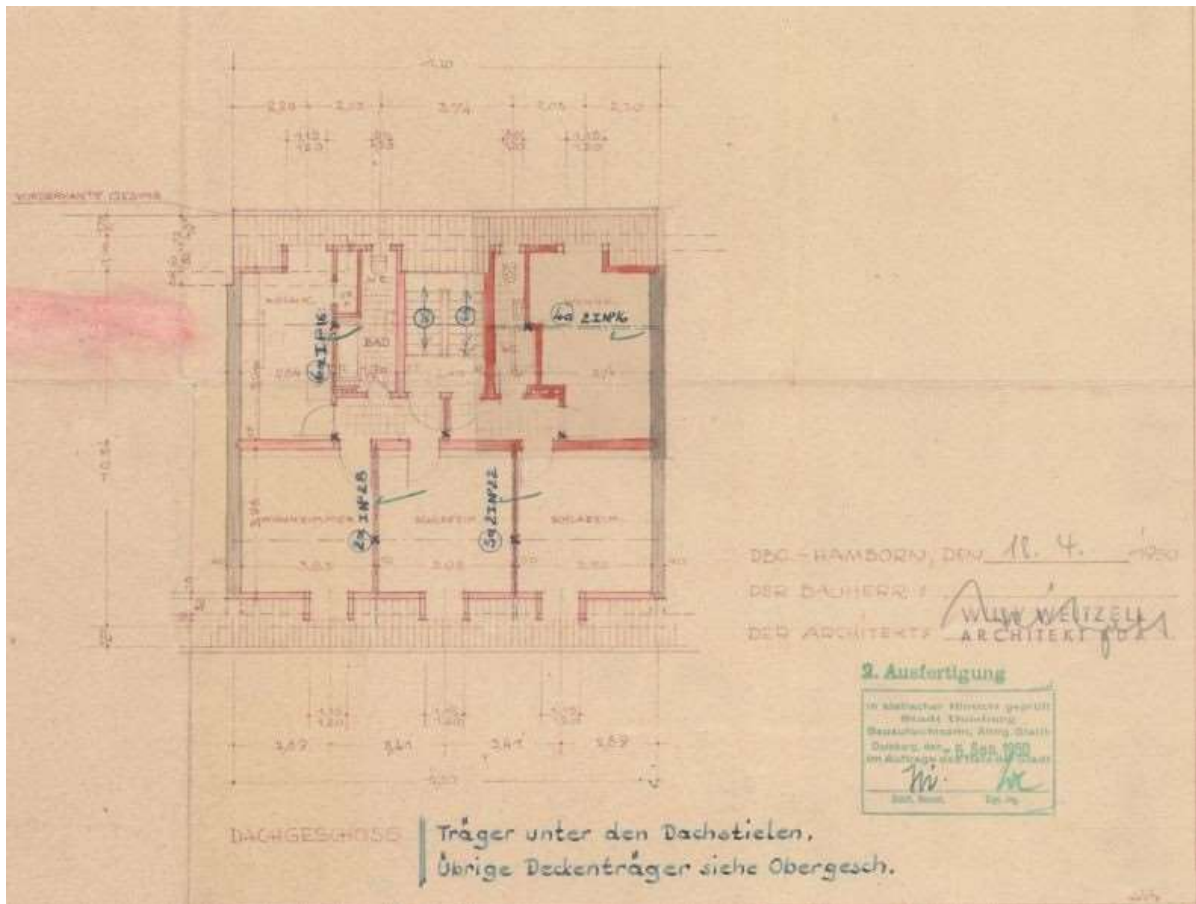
Grundriss Dachgeschoss (DG)
